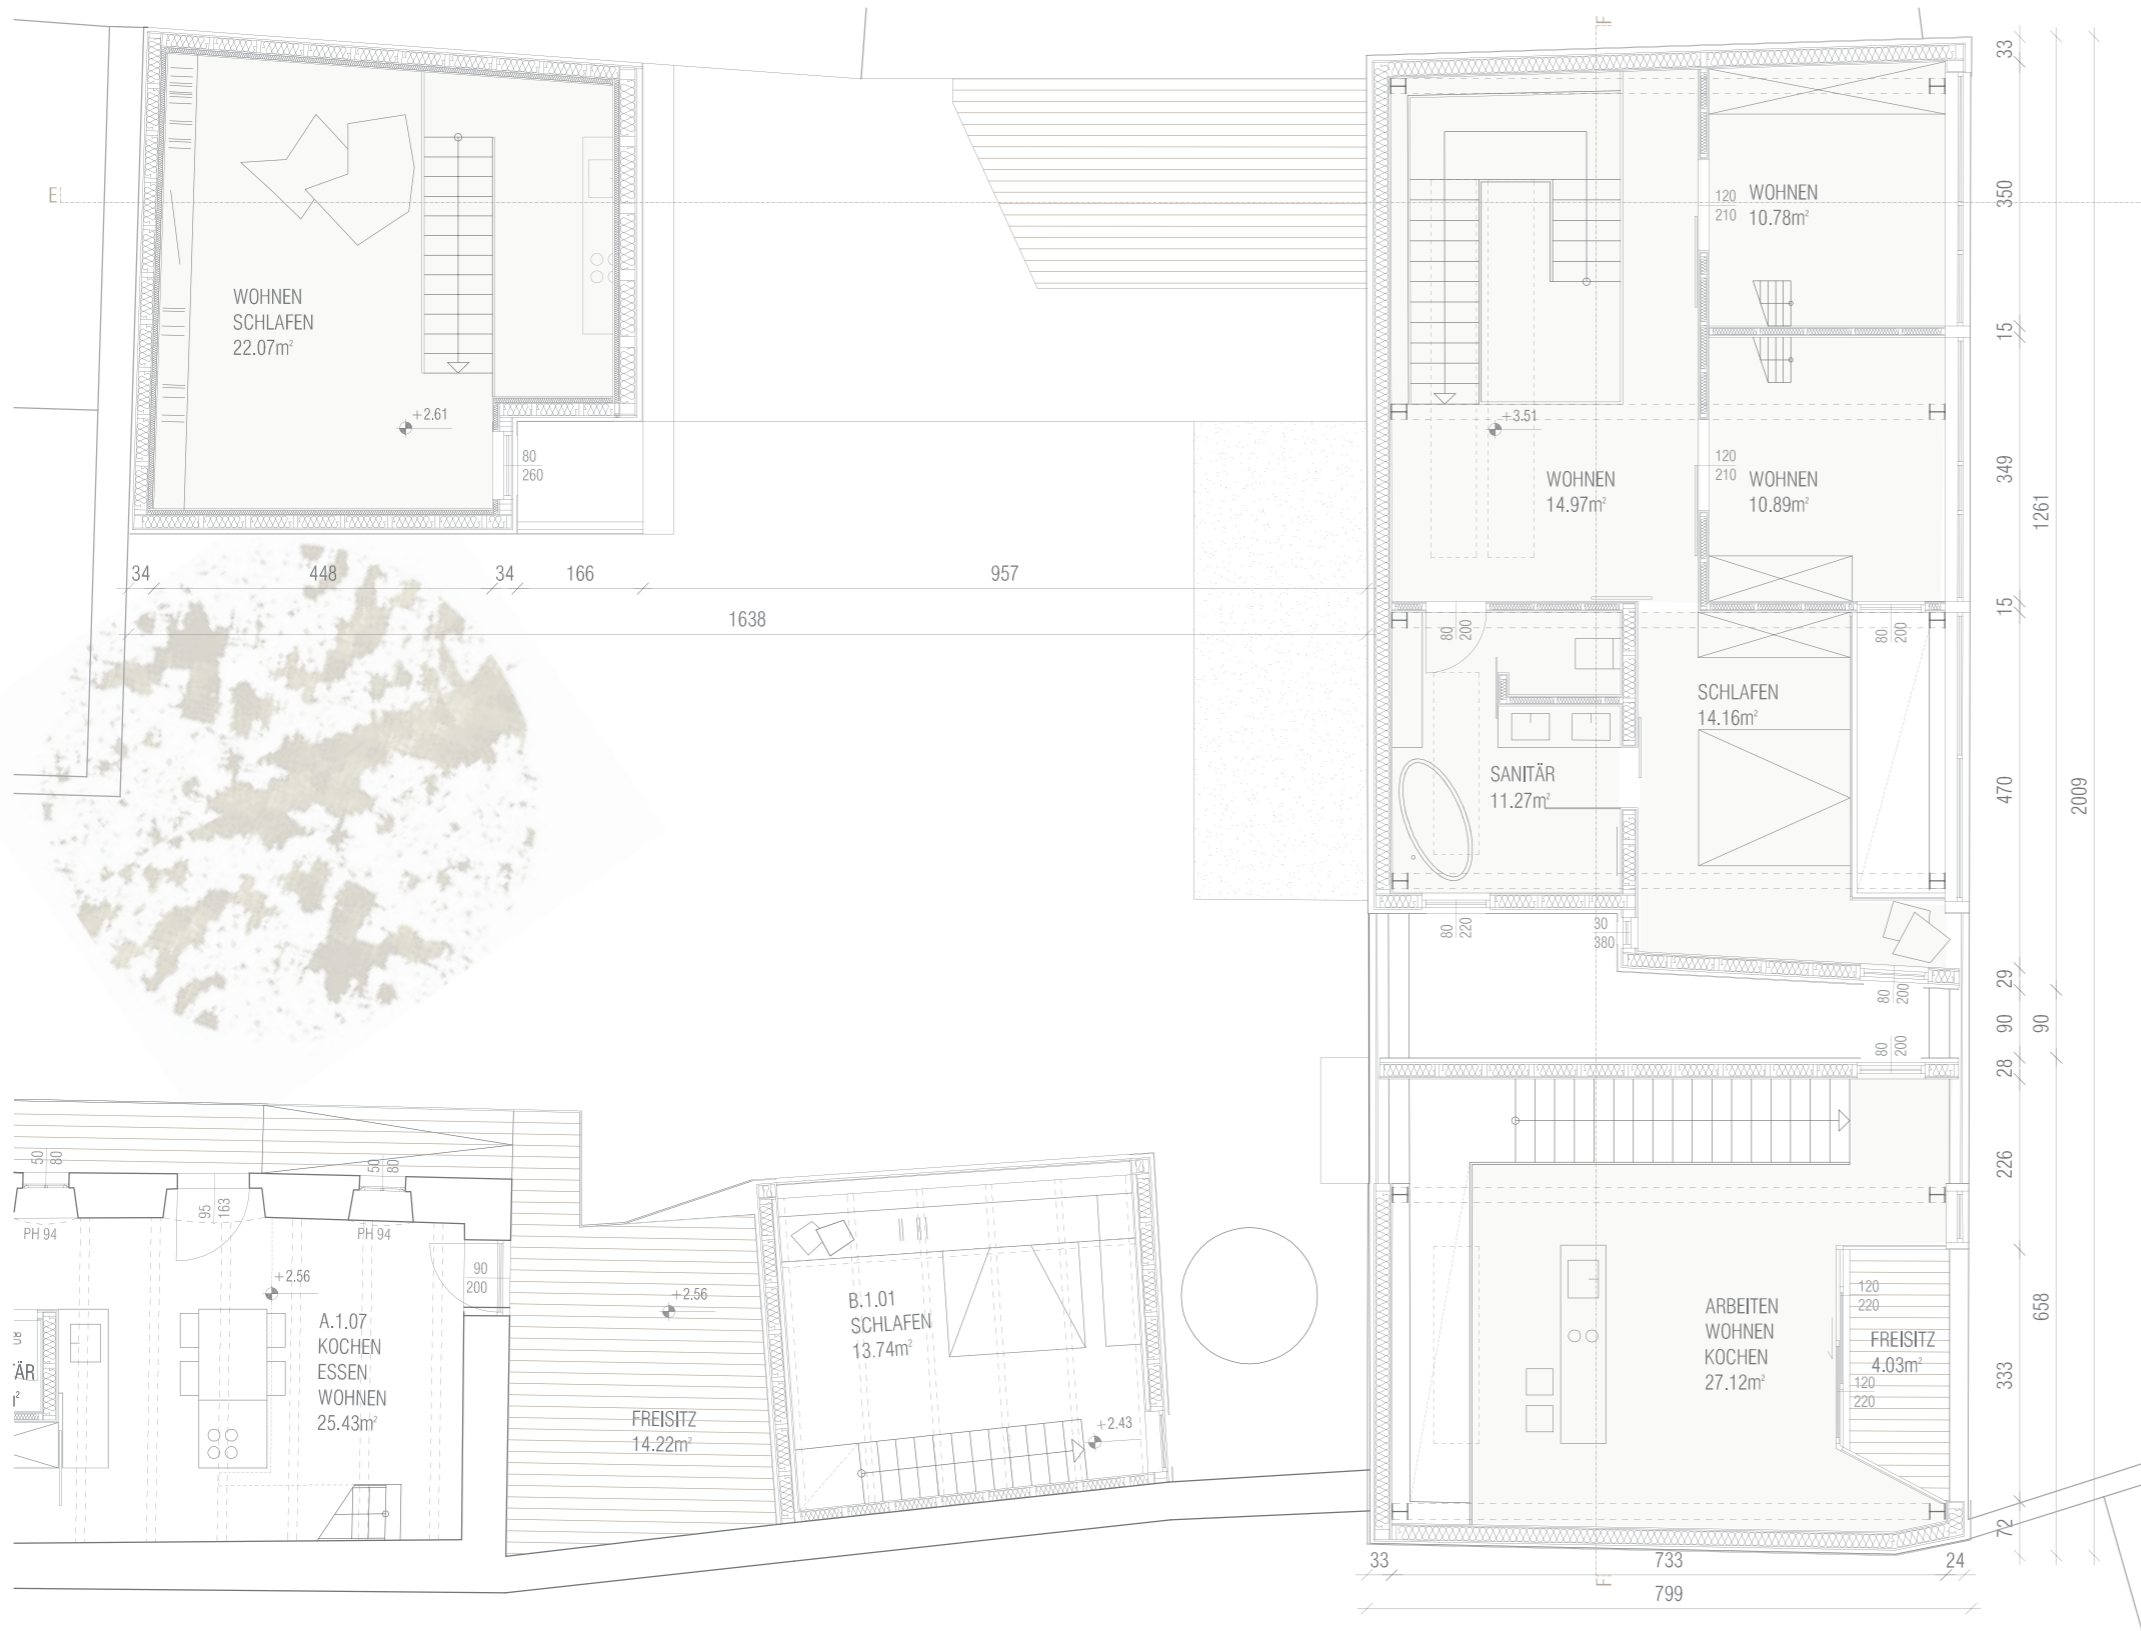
Gebäude C_ELTERNHAUS_Erweiterung_WERKHAUS_Grundriss Dachgeschoss Maßstab 1:100
